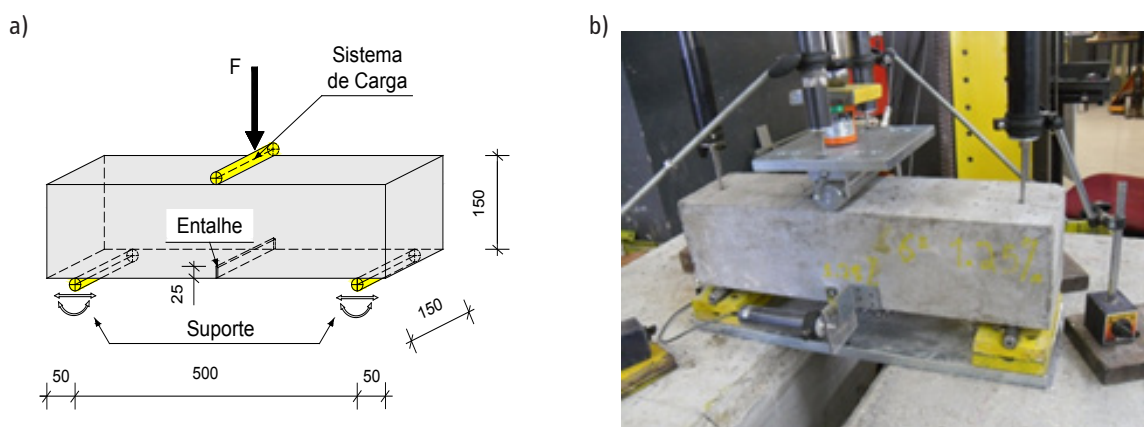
Vigas entalhadas: a) esquema (dimensões em mm) e b) realização de ensaio.
